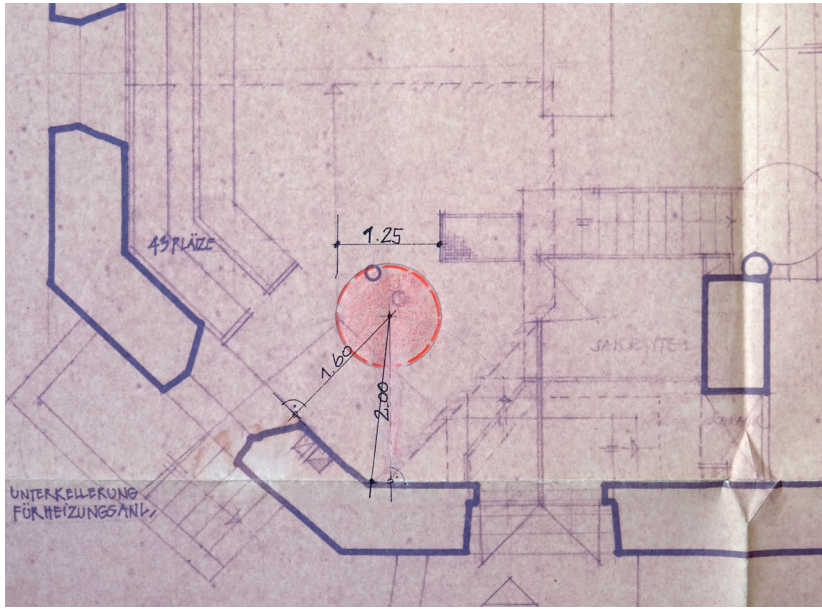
Architekt Delius zeichnete 1961 das gefundene Fundament in seinen Grundriss ein und maß die Abstände zur Außenwand; Ausschnitt. (LA NRW W, K 827 Nr. 130, Umschlag mit Zeichnungen)
